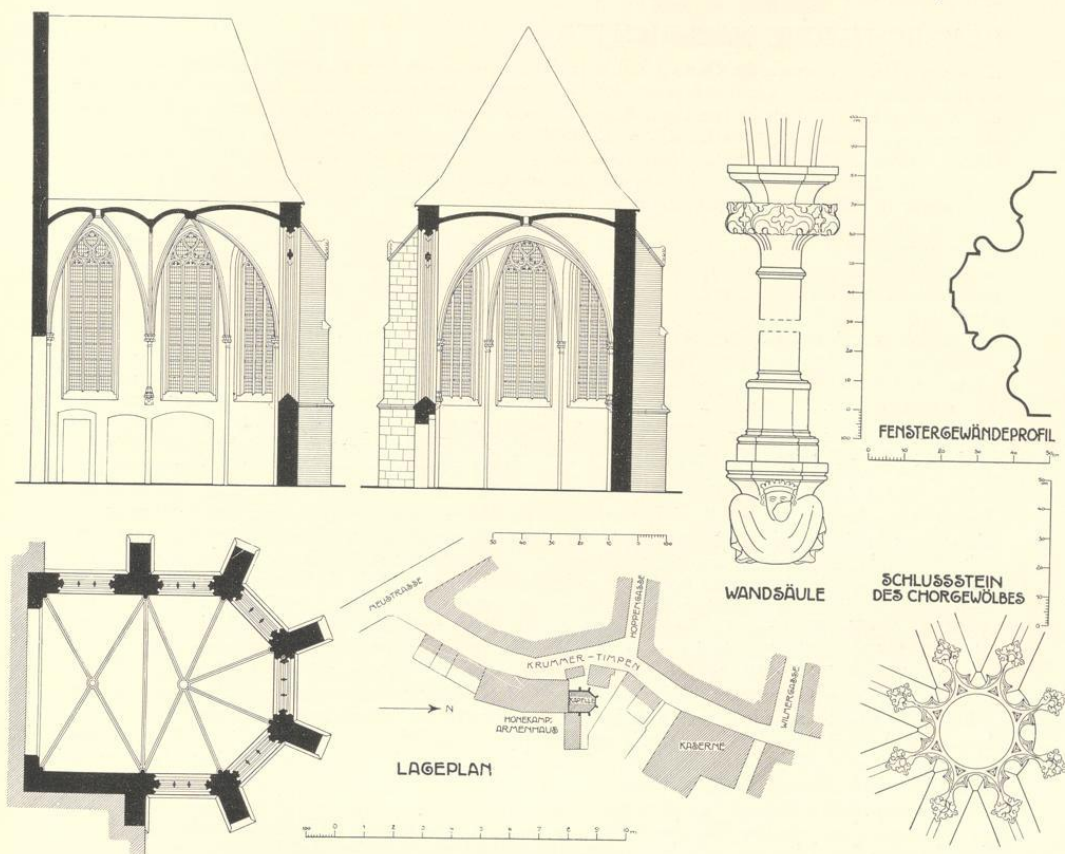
Lageplan, Grundriß, Längs- und Querschnitt und Einzelheiten der Kapelle des Armenhauses von der Wieck
